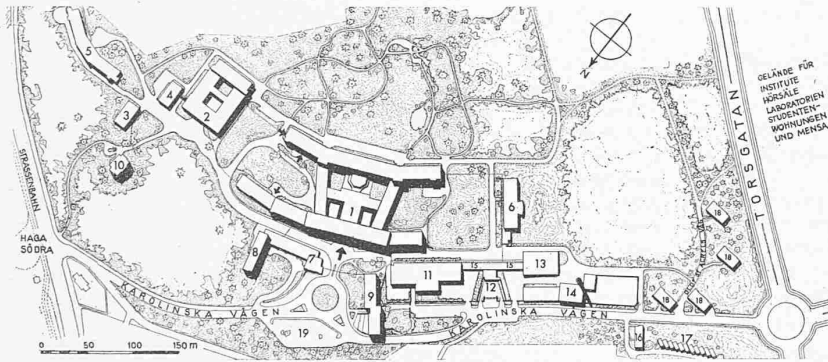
Karolinska Universitäts-Krankenhaus Stockholm. — Lageplan 1 : 7500
